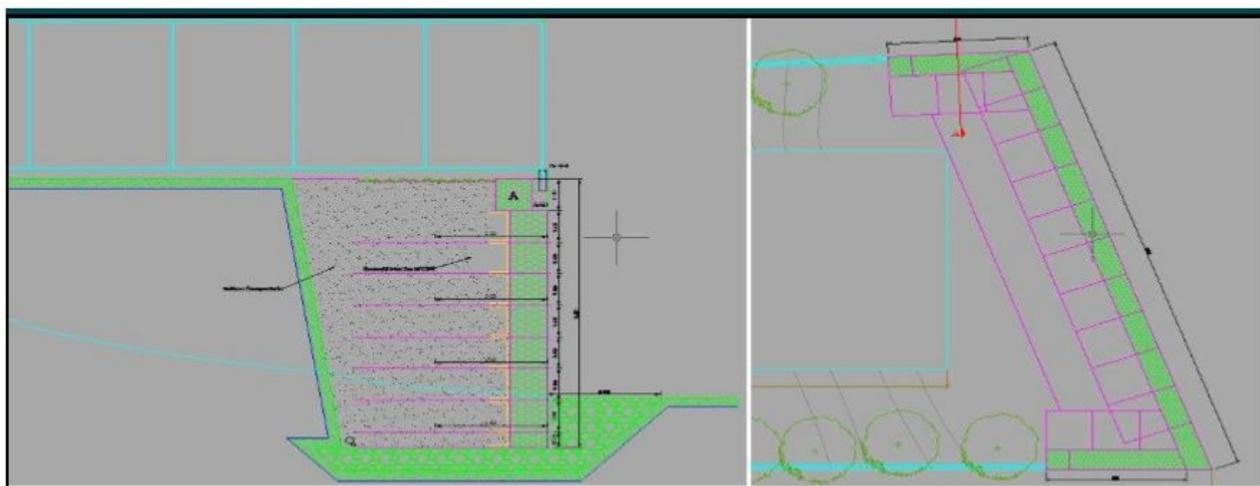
Vista CAD en corte y en planta del Terramesh System.
